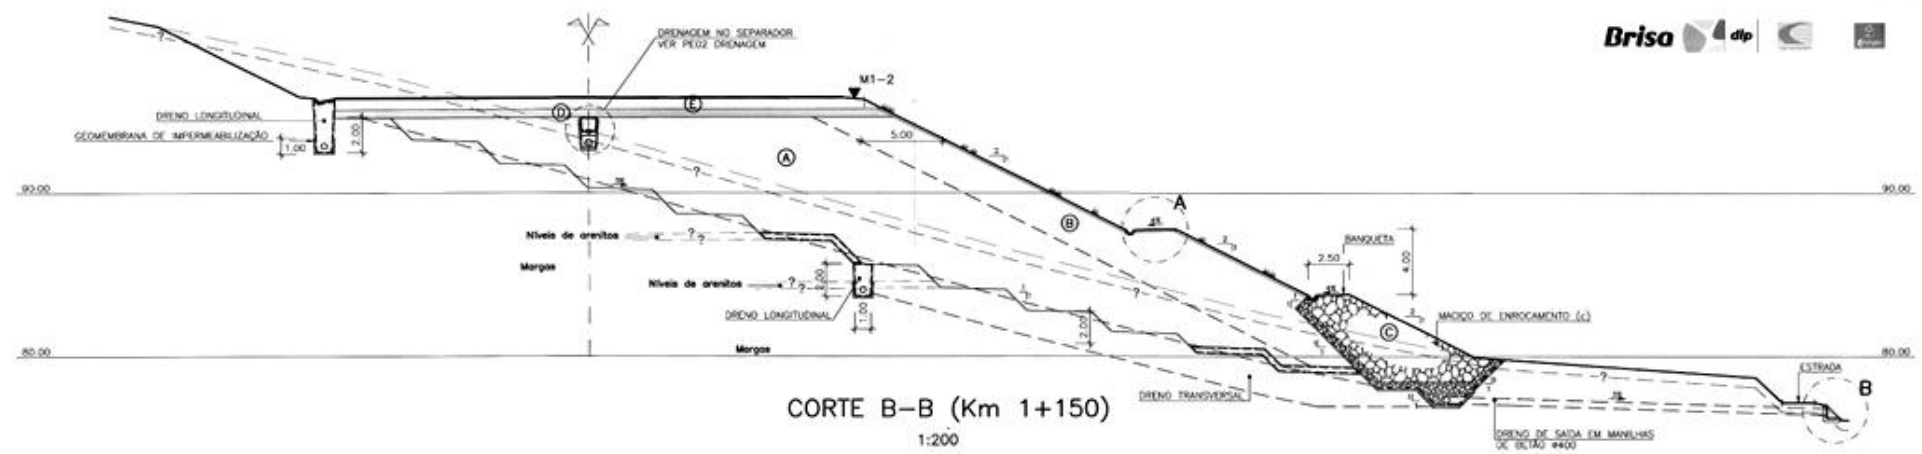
Perfil tipo do aterro AT1 da Auto-Estrada A10 (Cenorgeo, 2002)
